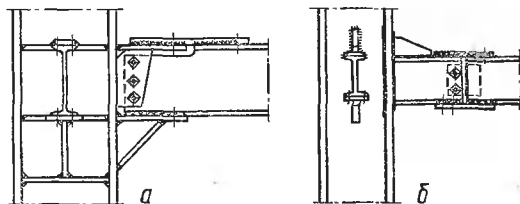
Типы узлов жесткого опирания ригелей на колонну:
